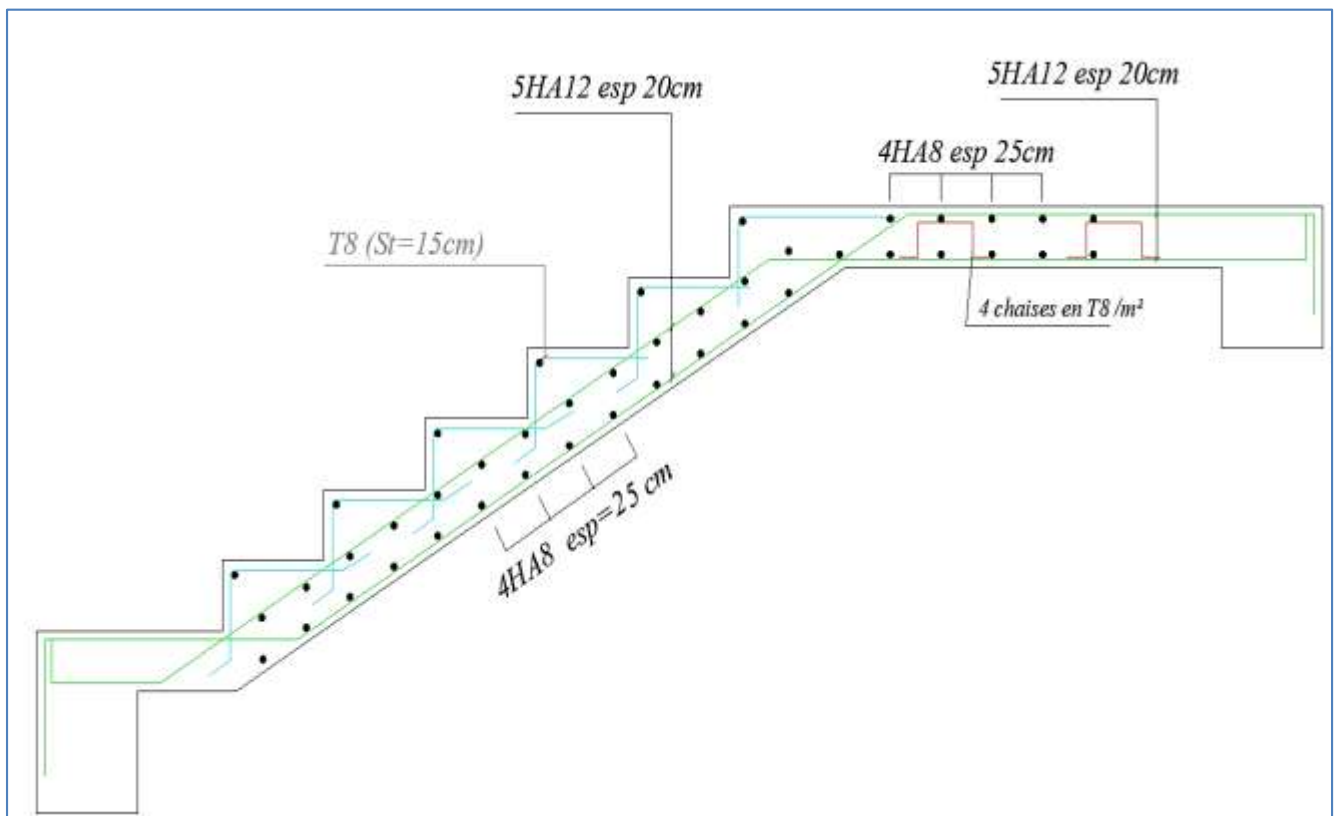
Ferrailage de la 1^{ère} et la 3^{ème} volée de l'escalier
